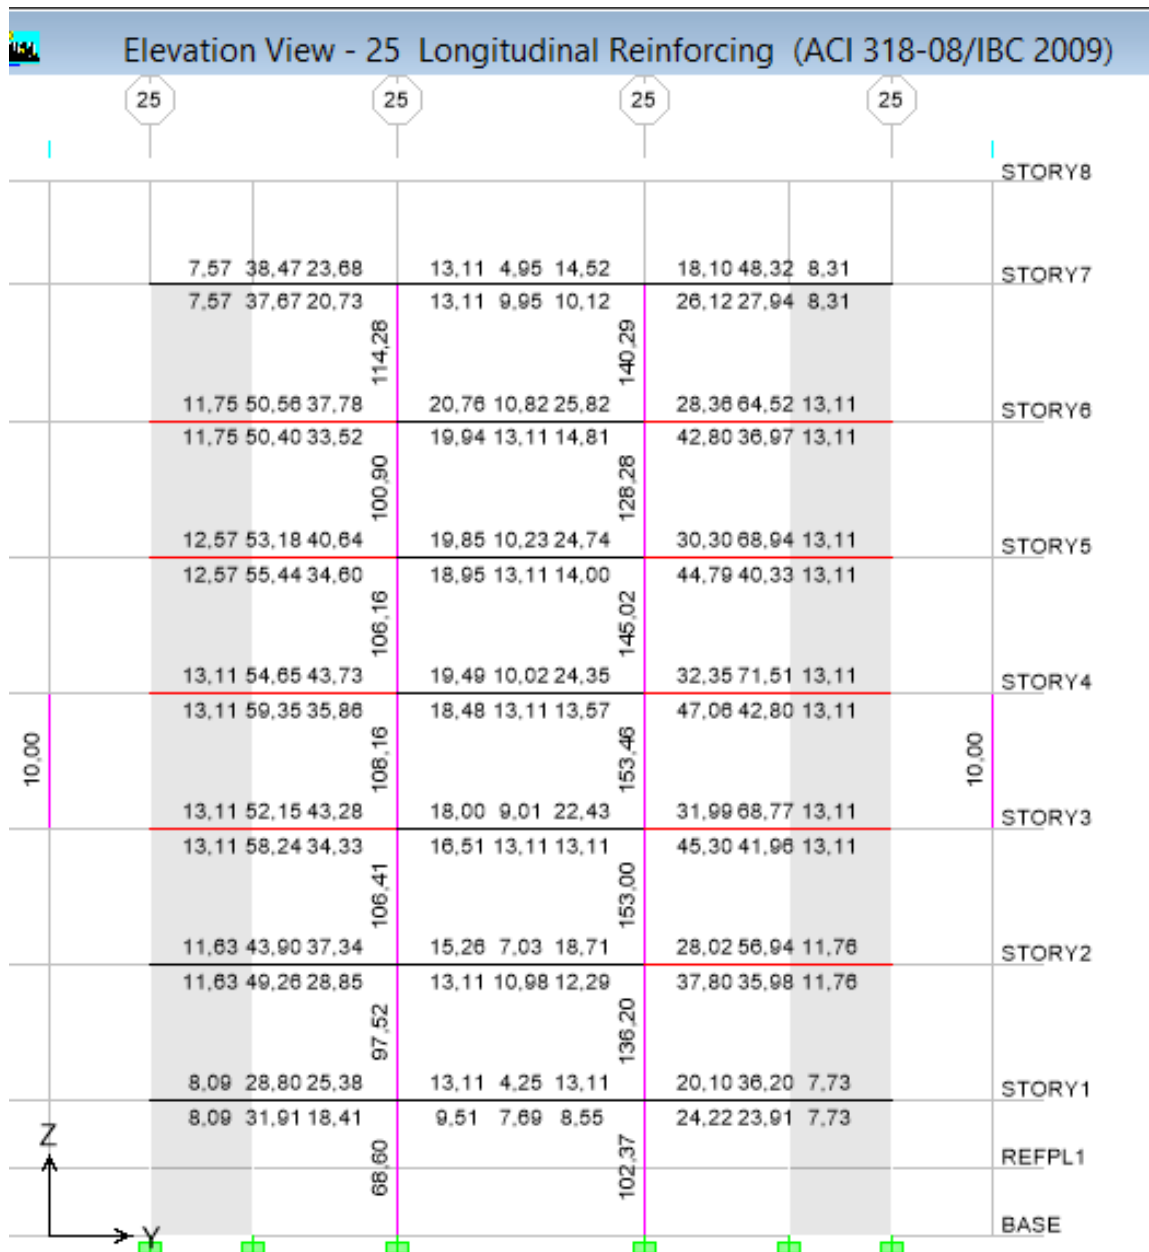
Acero en Vigas y Columnas en el Pórtico 25 – Hospitalización 2- (NEC-11)
